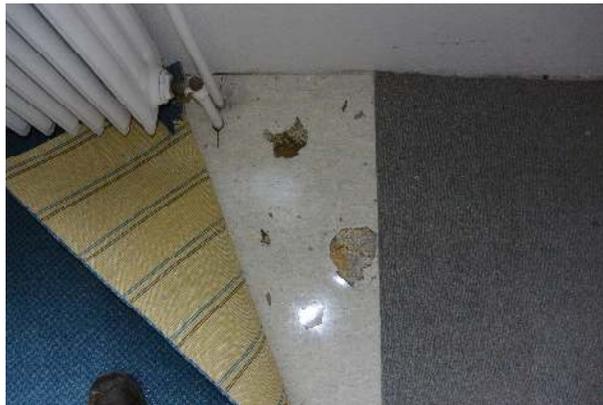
Öffnung Bodenbelag, 3. OG (Straßenseite)
